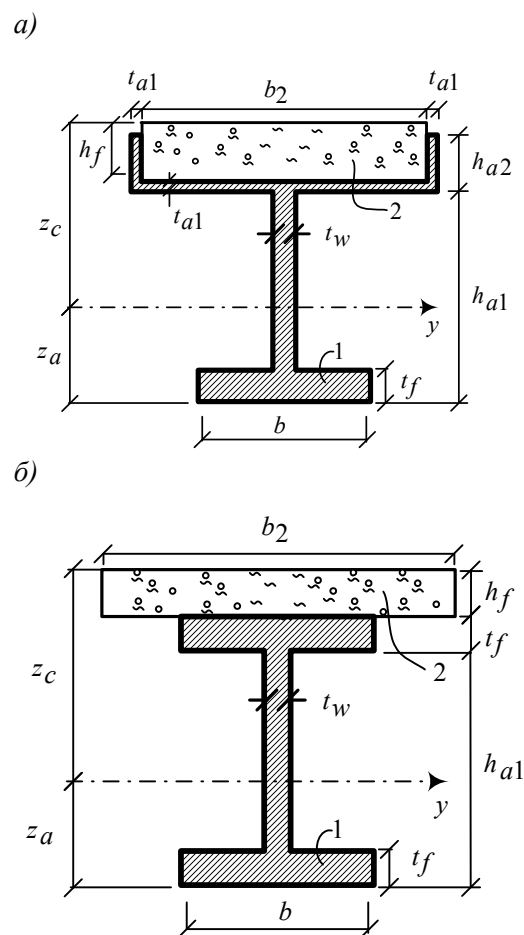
Поперечное сечение сталежелезобетонной балки:
